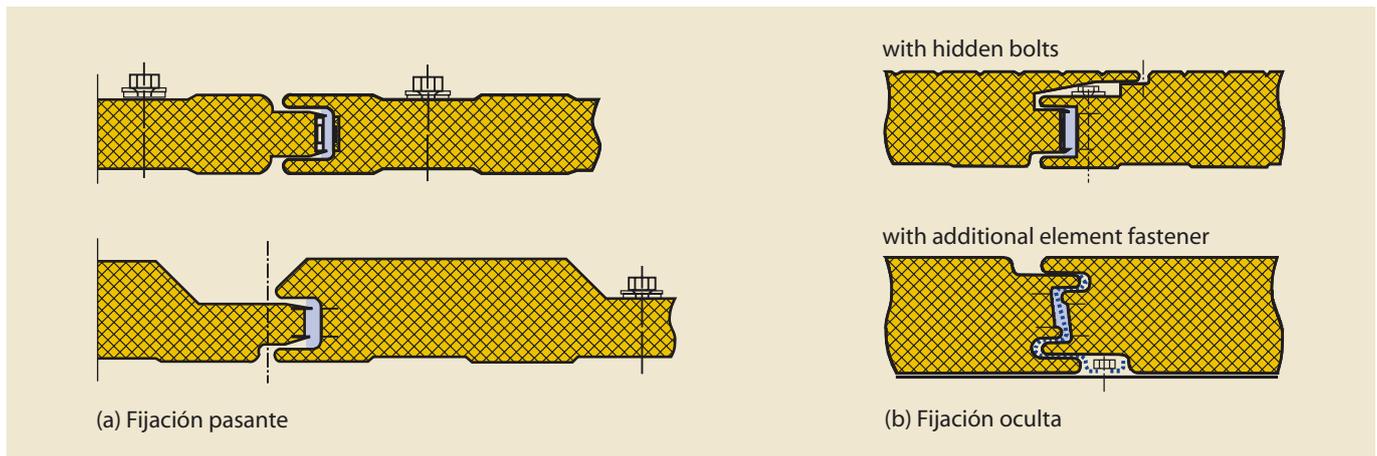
(Arriba) Ejemplos de métodos de fijación para paneles sándwich. Stahl-Informations-Zentrum: Dach und Fassadenelemente aus Stahl - Erfolgreich Planen und Konstruieren, Dokumentation 588, Düsseldorf, 2005
